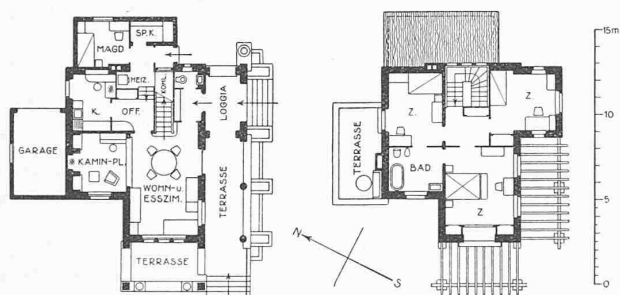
Grundrisse des Hauses F. am Cap d'Antibes. — 1 : 400.
